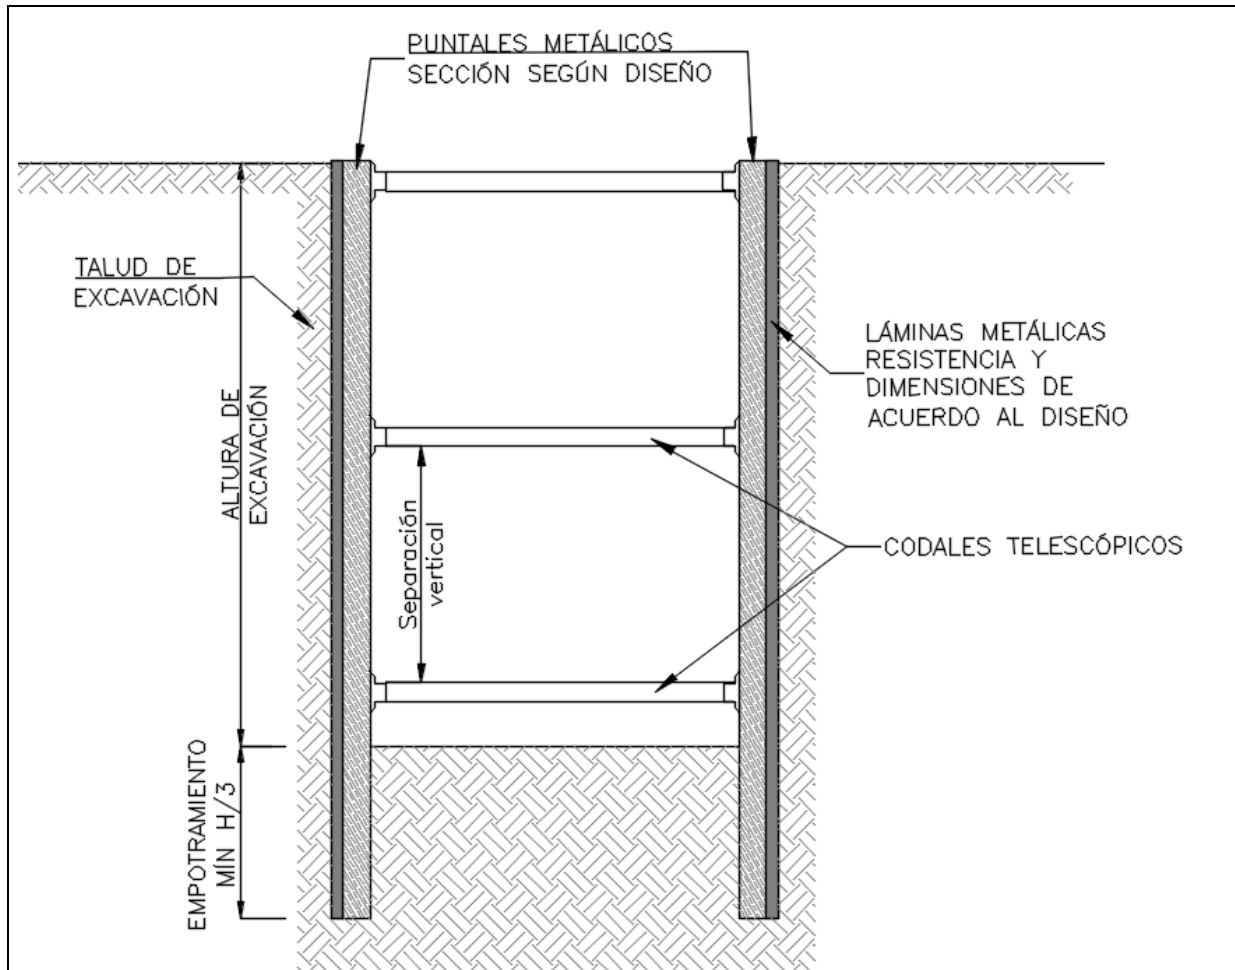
Entibado continuo con láminas metálicas – Sección transversal
